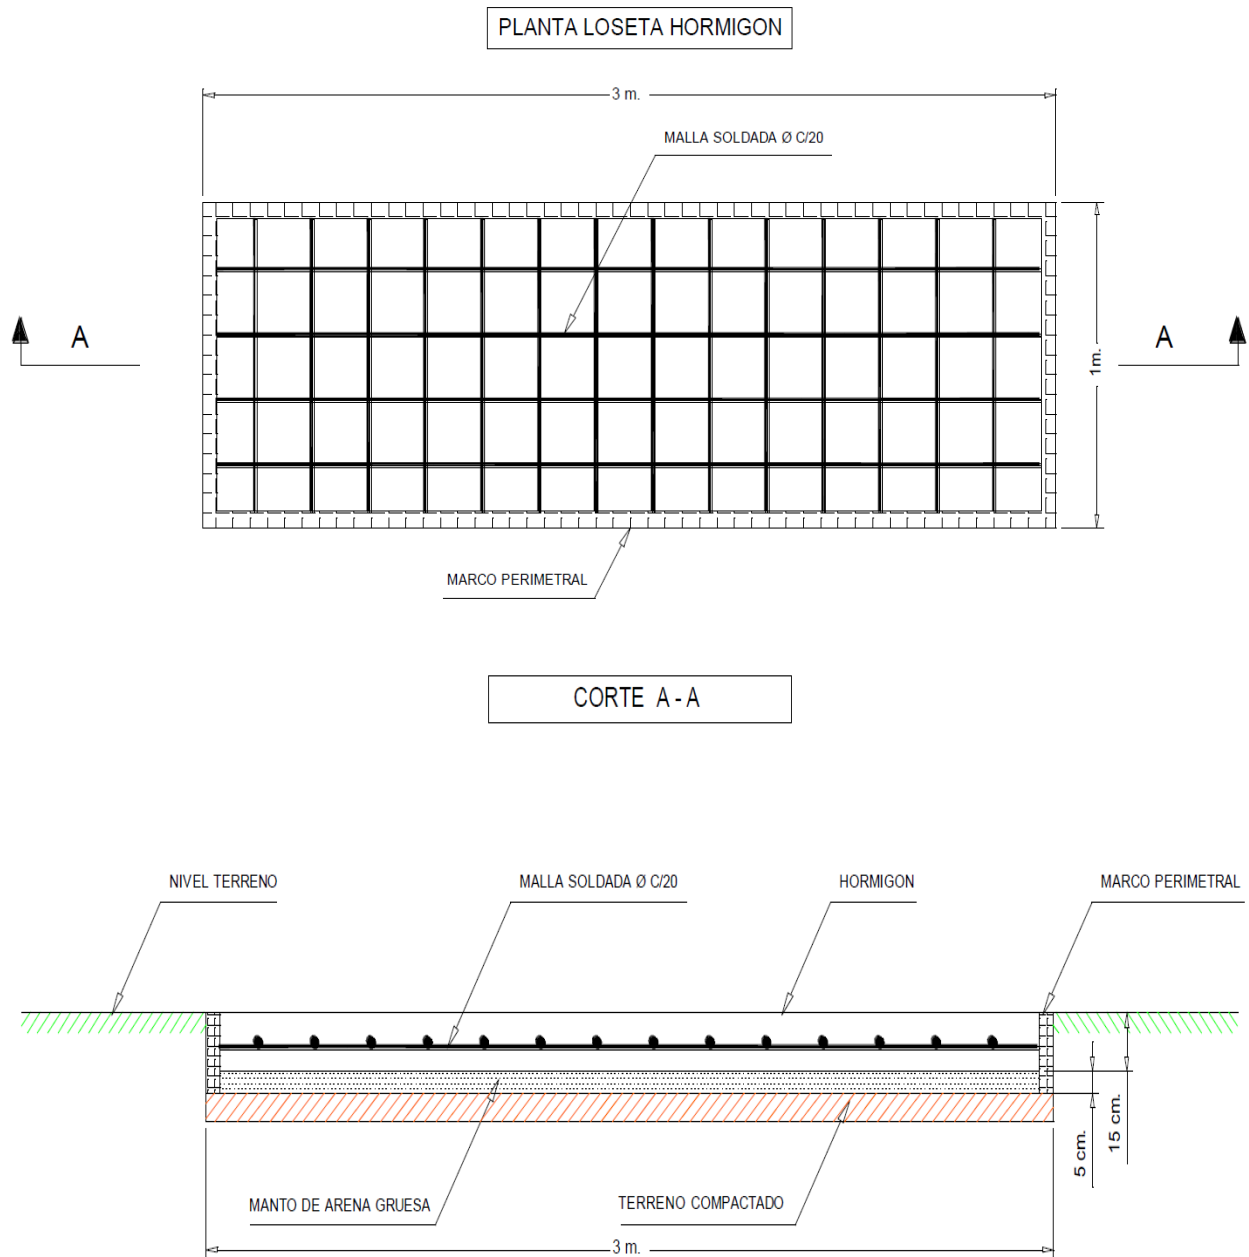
Características constructivas sugeridas para las señales de borde de pista no pavimentada
